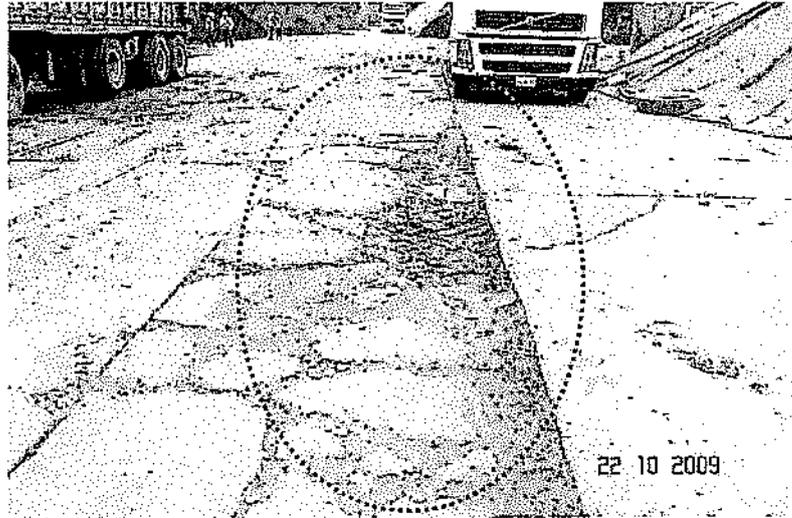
(Obs.1, 2009) : Losas deterioradas, en dirección al depósito de plomo
